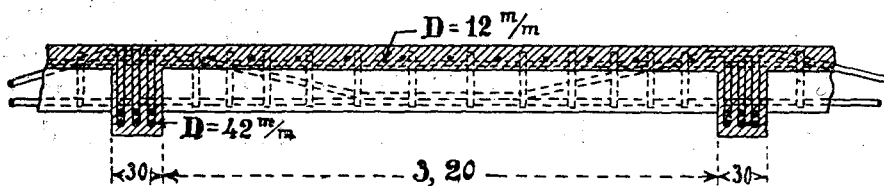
Suelo de hormigón armado en el «Bon Marché» de París; corte perpendicular al eje de las vigas maestras.
